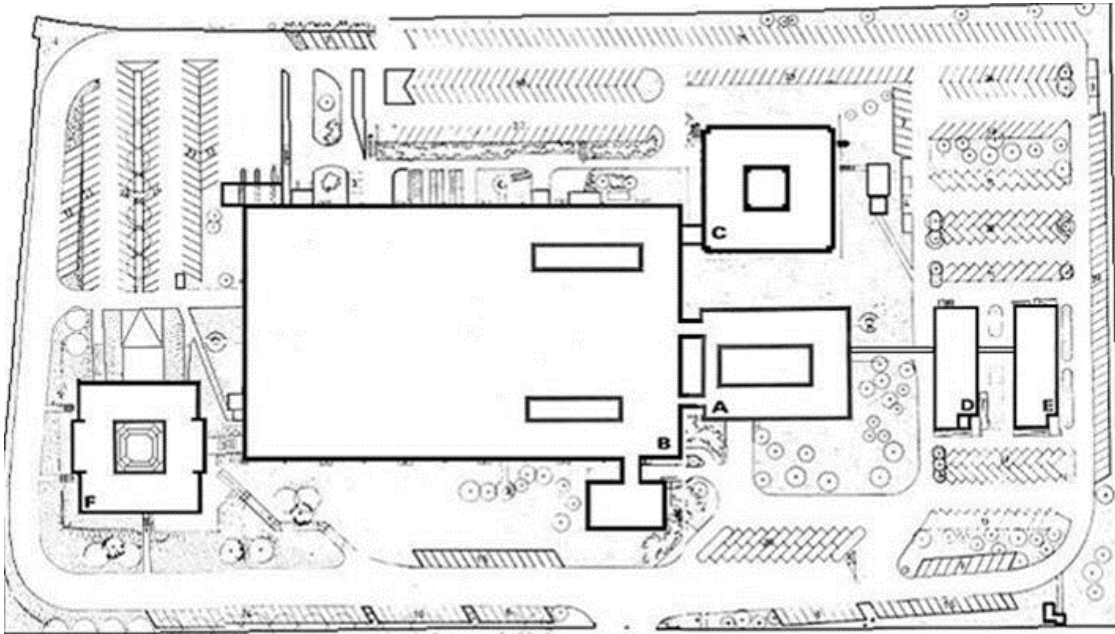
Plan masse du site avant la démolition des bâtiments D et E
